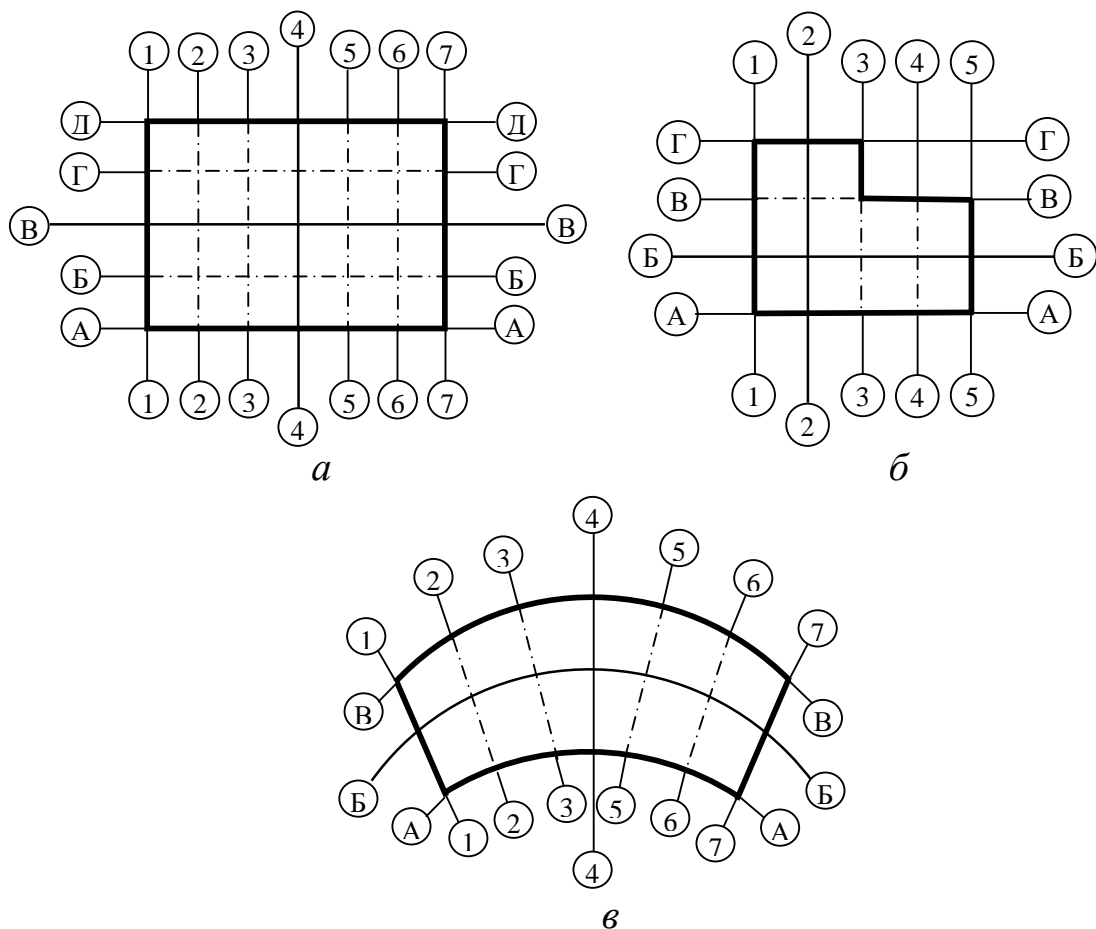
Схеми розмічування осей споруд: *а* – прямокутна будівля; *б* – Г-подібна будівля; *в* – криволінійна будівля
